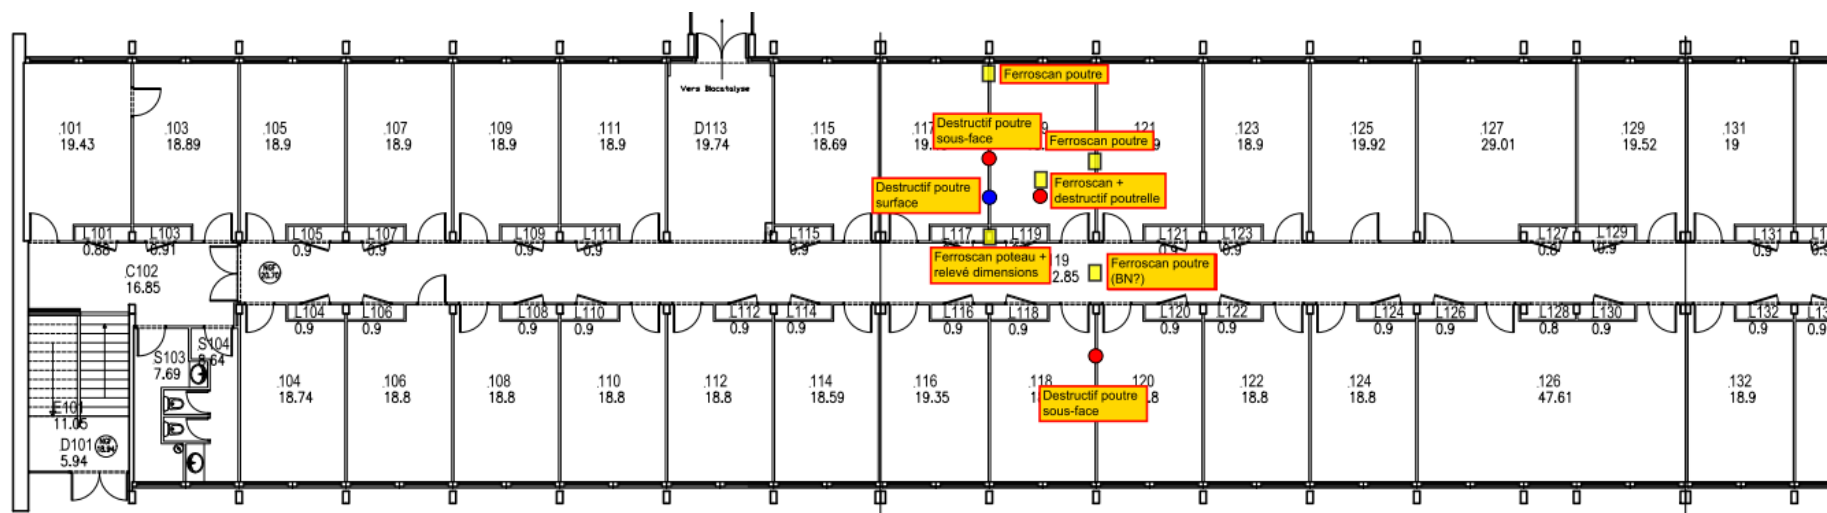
BATIMENT 10 – Plancher haut niveau 1
